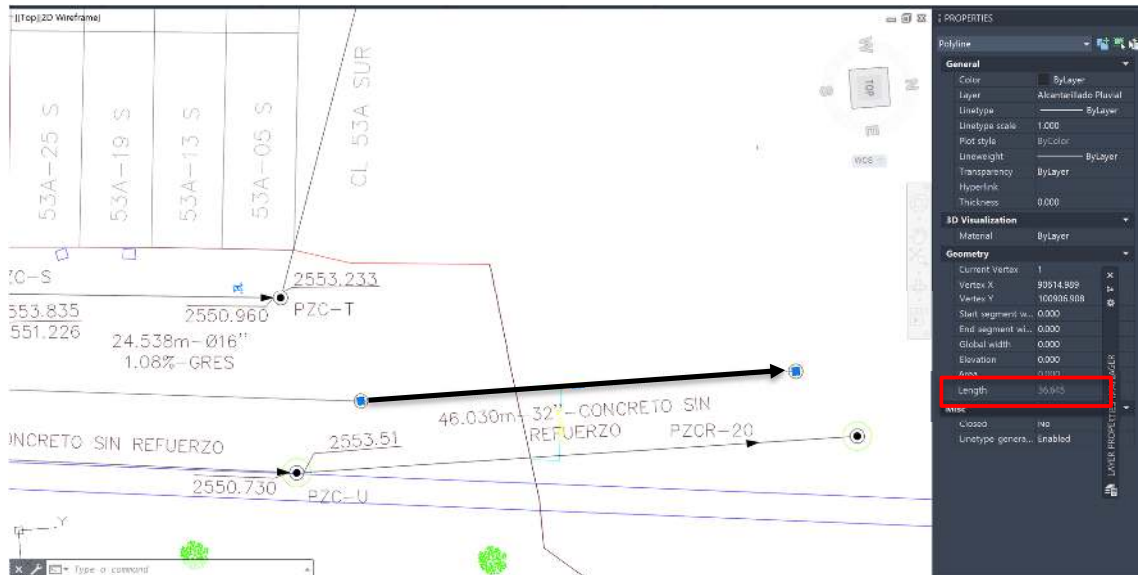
Cuantificación de longitud alcantarillado pluvial D 36".
